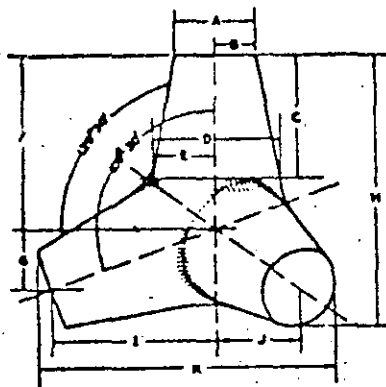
ELEMENTOS DE CONCRETO PREFABRICADOS
